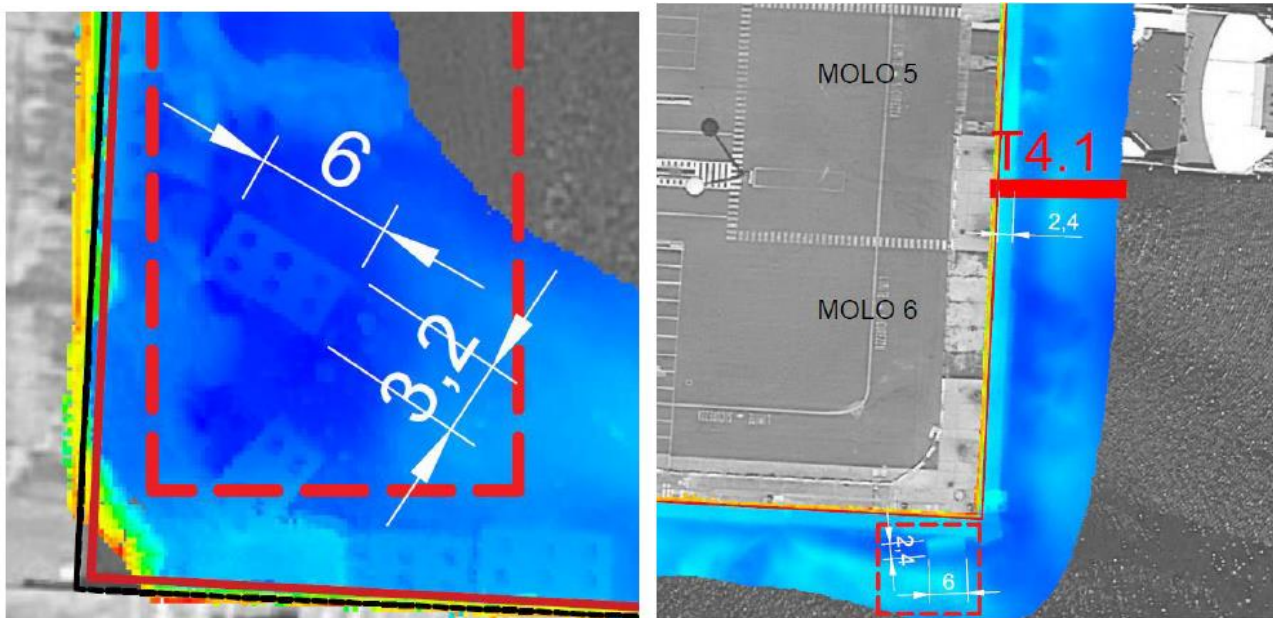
Massi guardiani rilevati al piede delle banchine.
